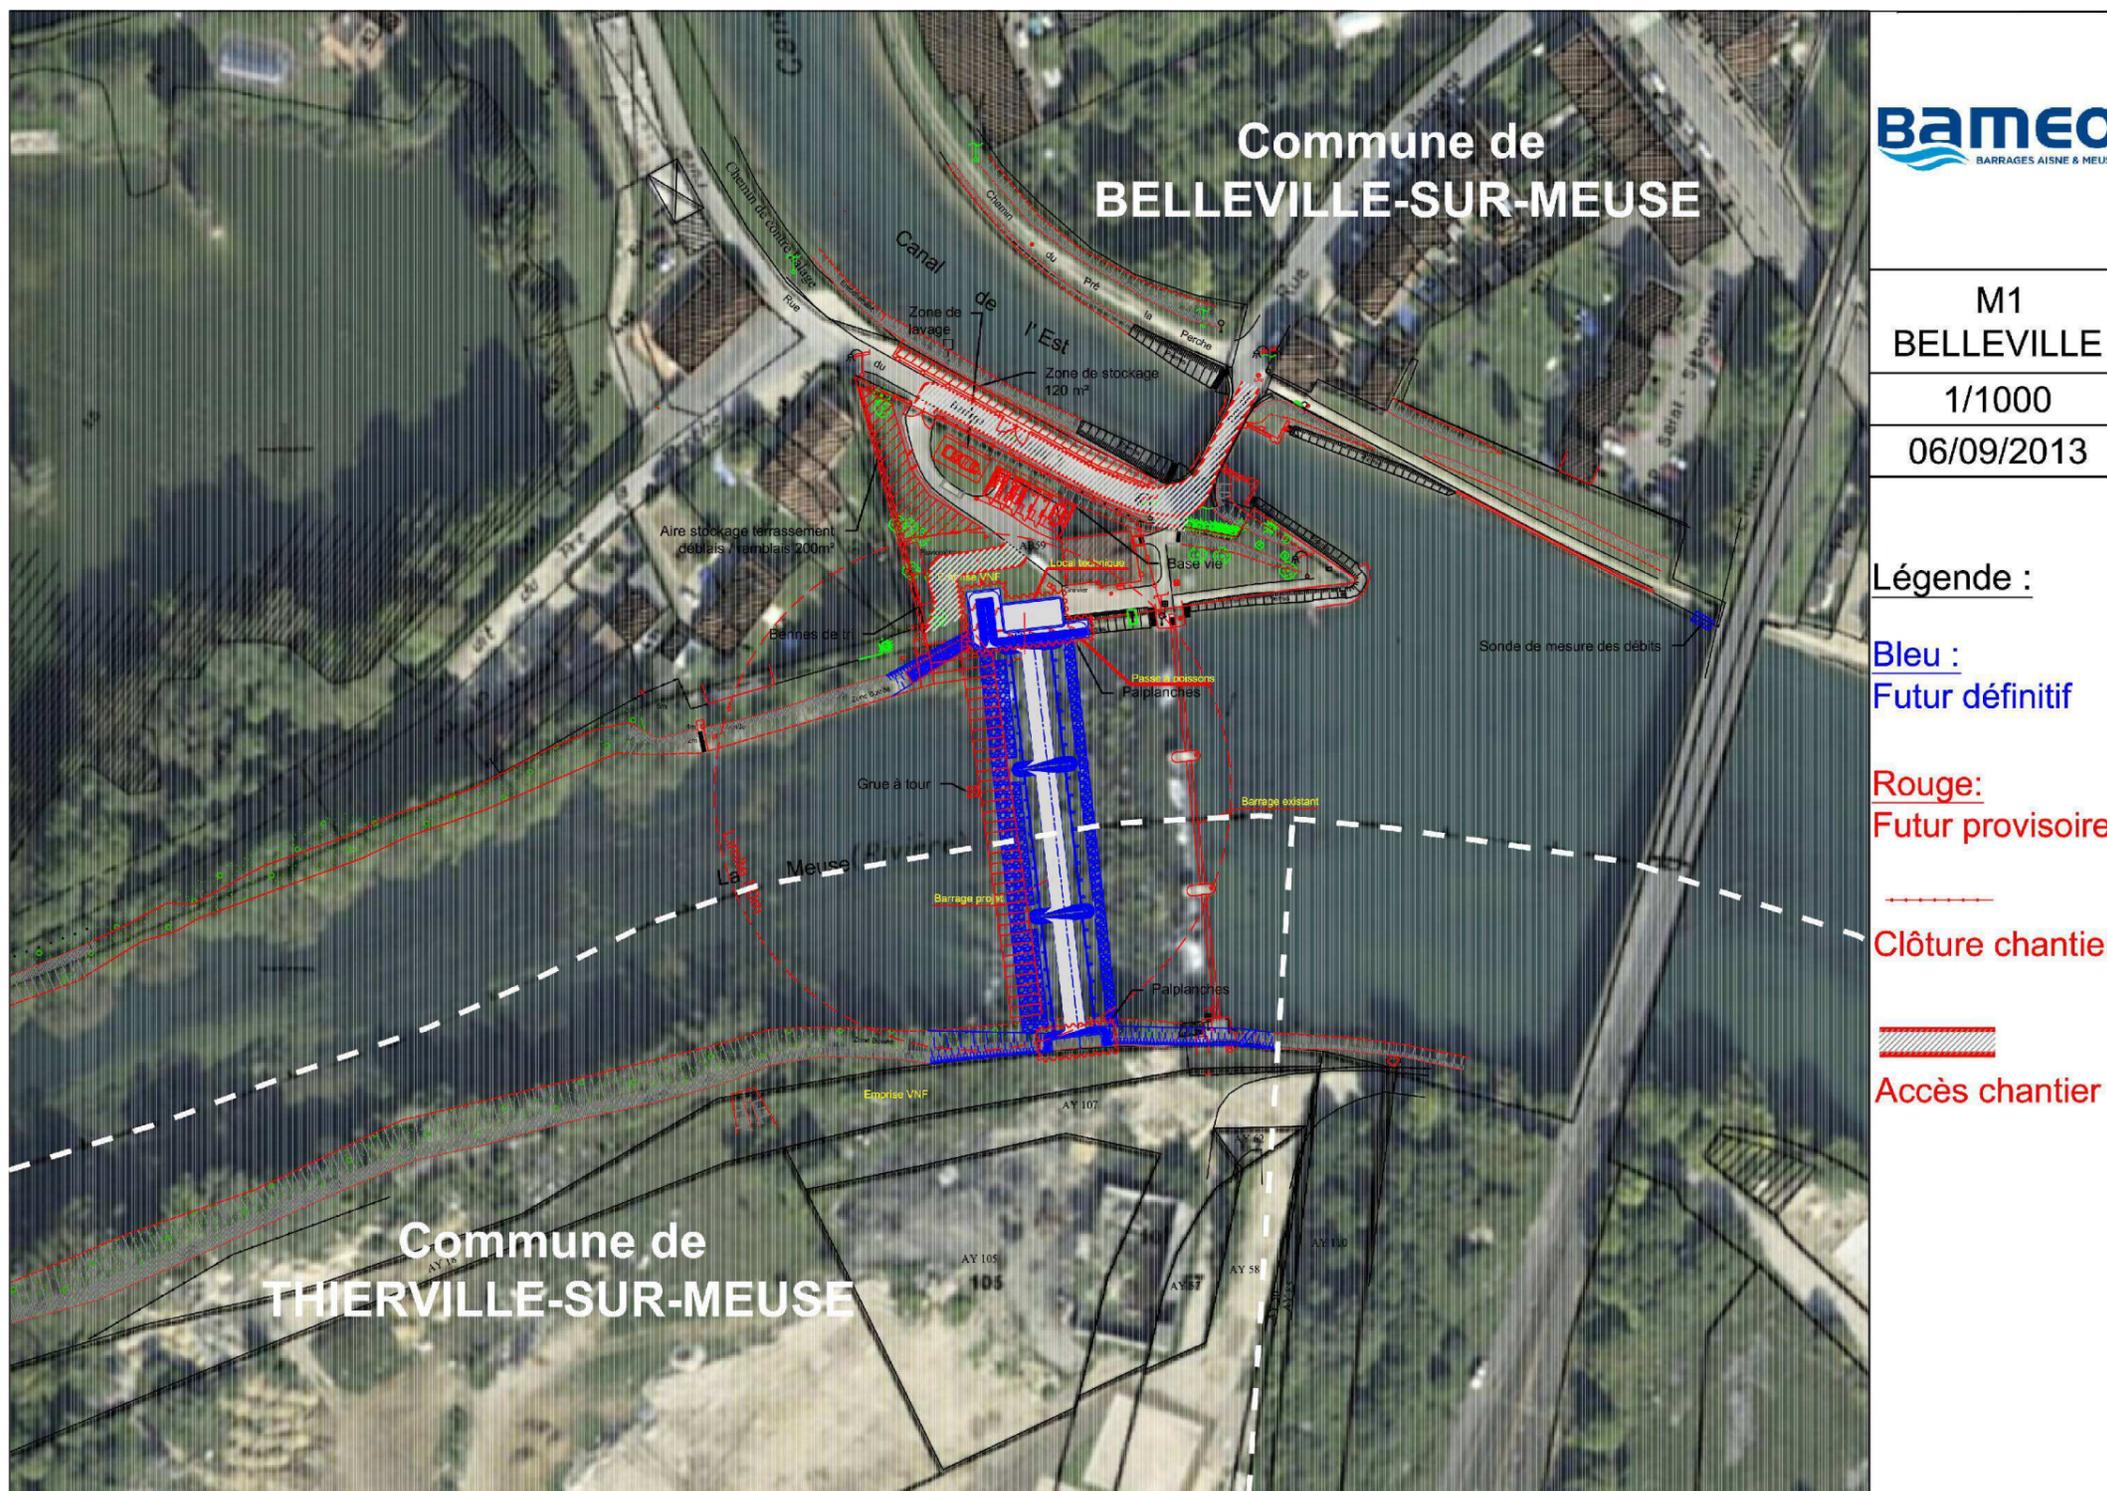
Localisation du barrage M01 - BELLEVILLE sur la commune de BELLEVILLE-SUR-MEUSE
